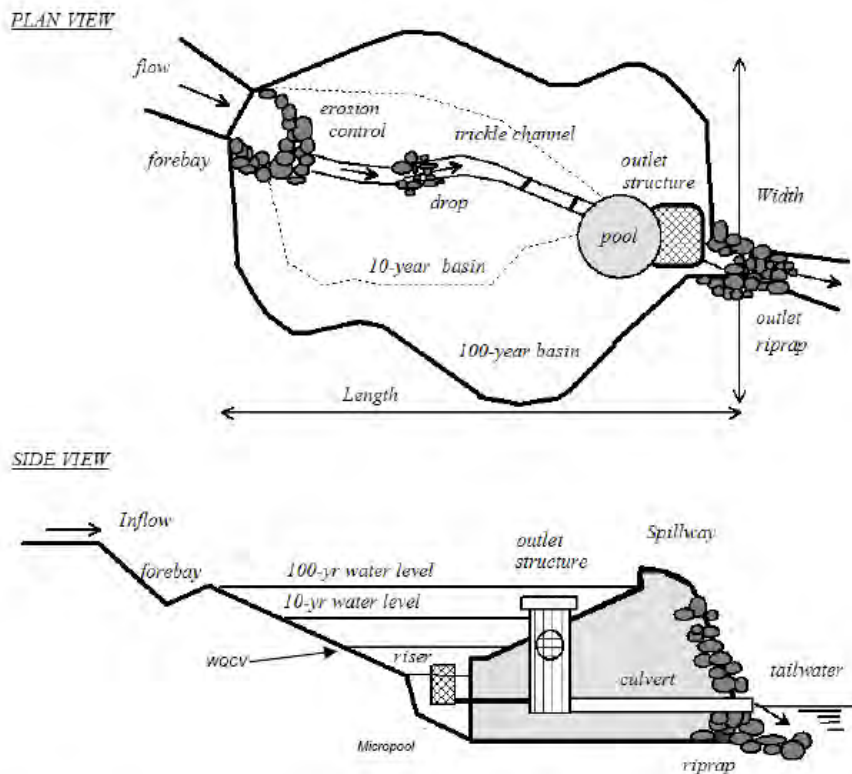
Esquemas en planta y alzado del embalse de retención de contaminantes
